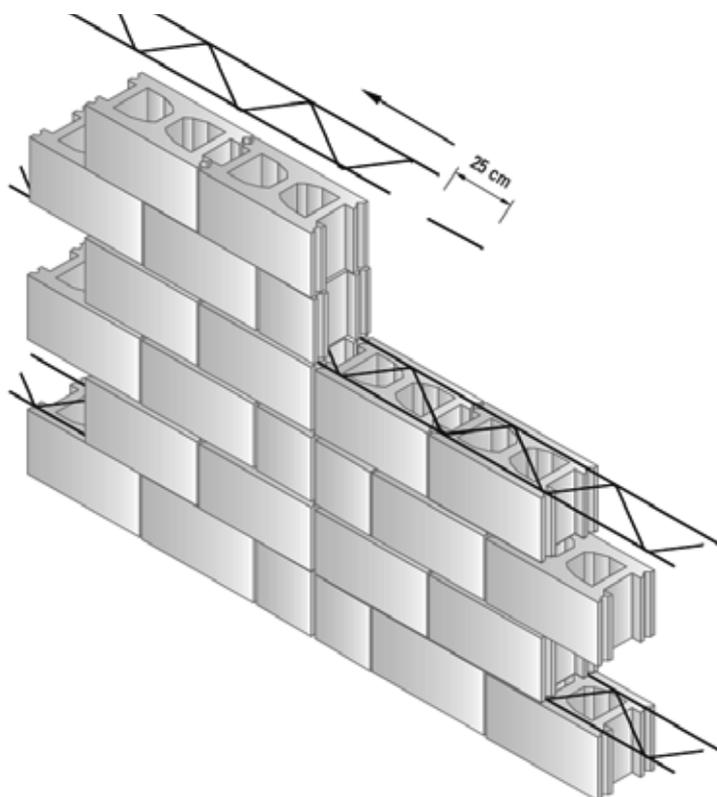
Junta de movimiento con armadura de tendel deslizante.
